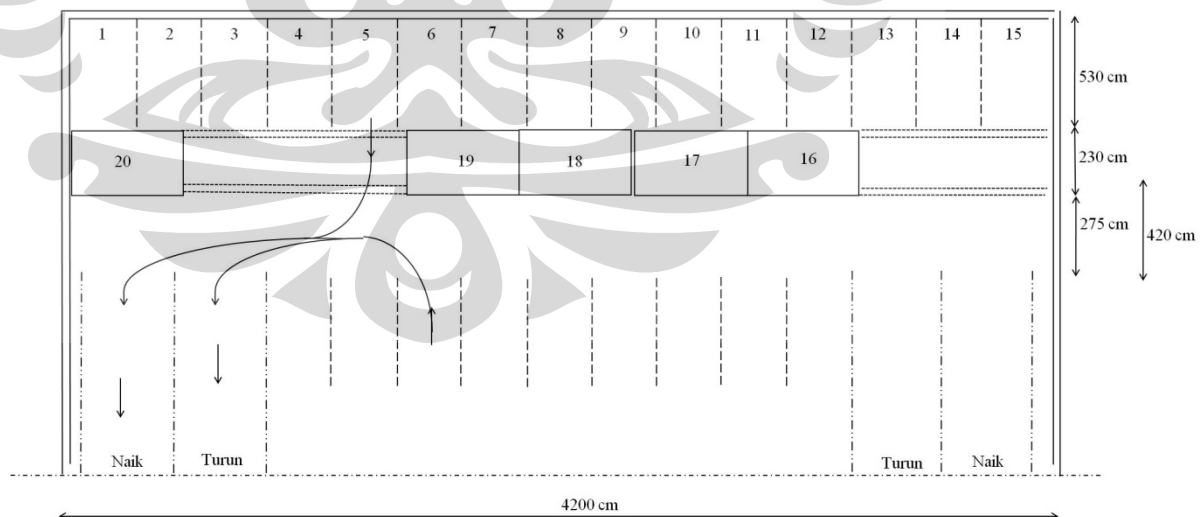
Detail sistem parkir *sliding platform longitudinal 1
